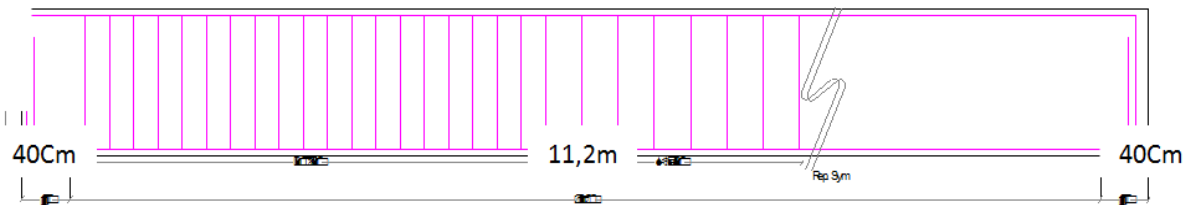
Croquis de ferrailage des poutres (L=12m)
